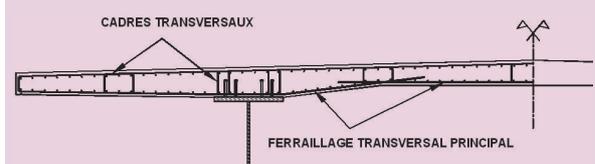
Principe de ferrailage courant de la dalle d'un tablier sans pièce de pont (hors ancrage des dispositifs de retenue)
